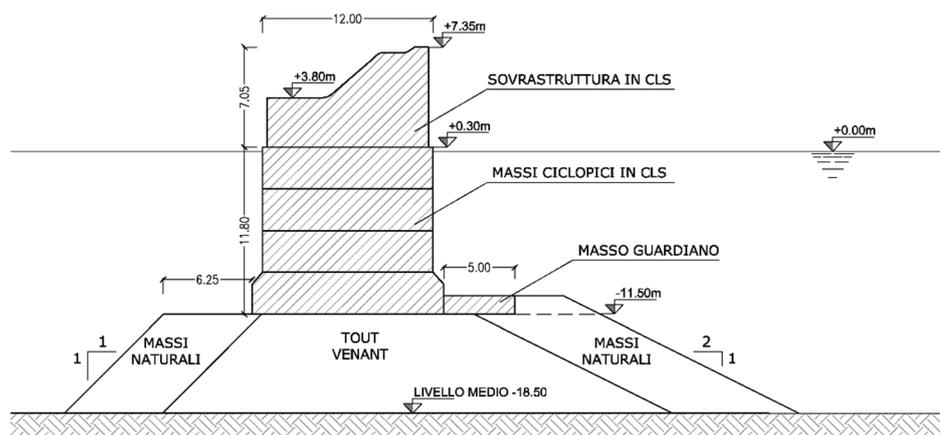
SEZIONE TIPO TRATTO ALL'ESTREMITÀ DI PONENTE DELLA DIGA ESISTENTE. TRATTO C-C'
